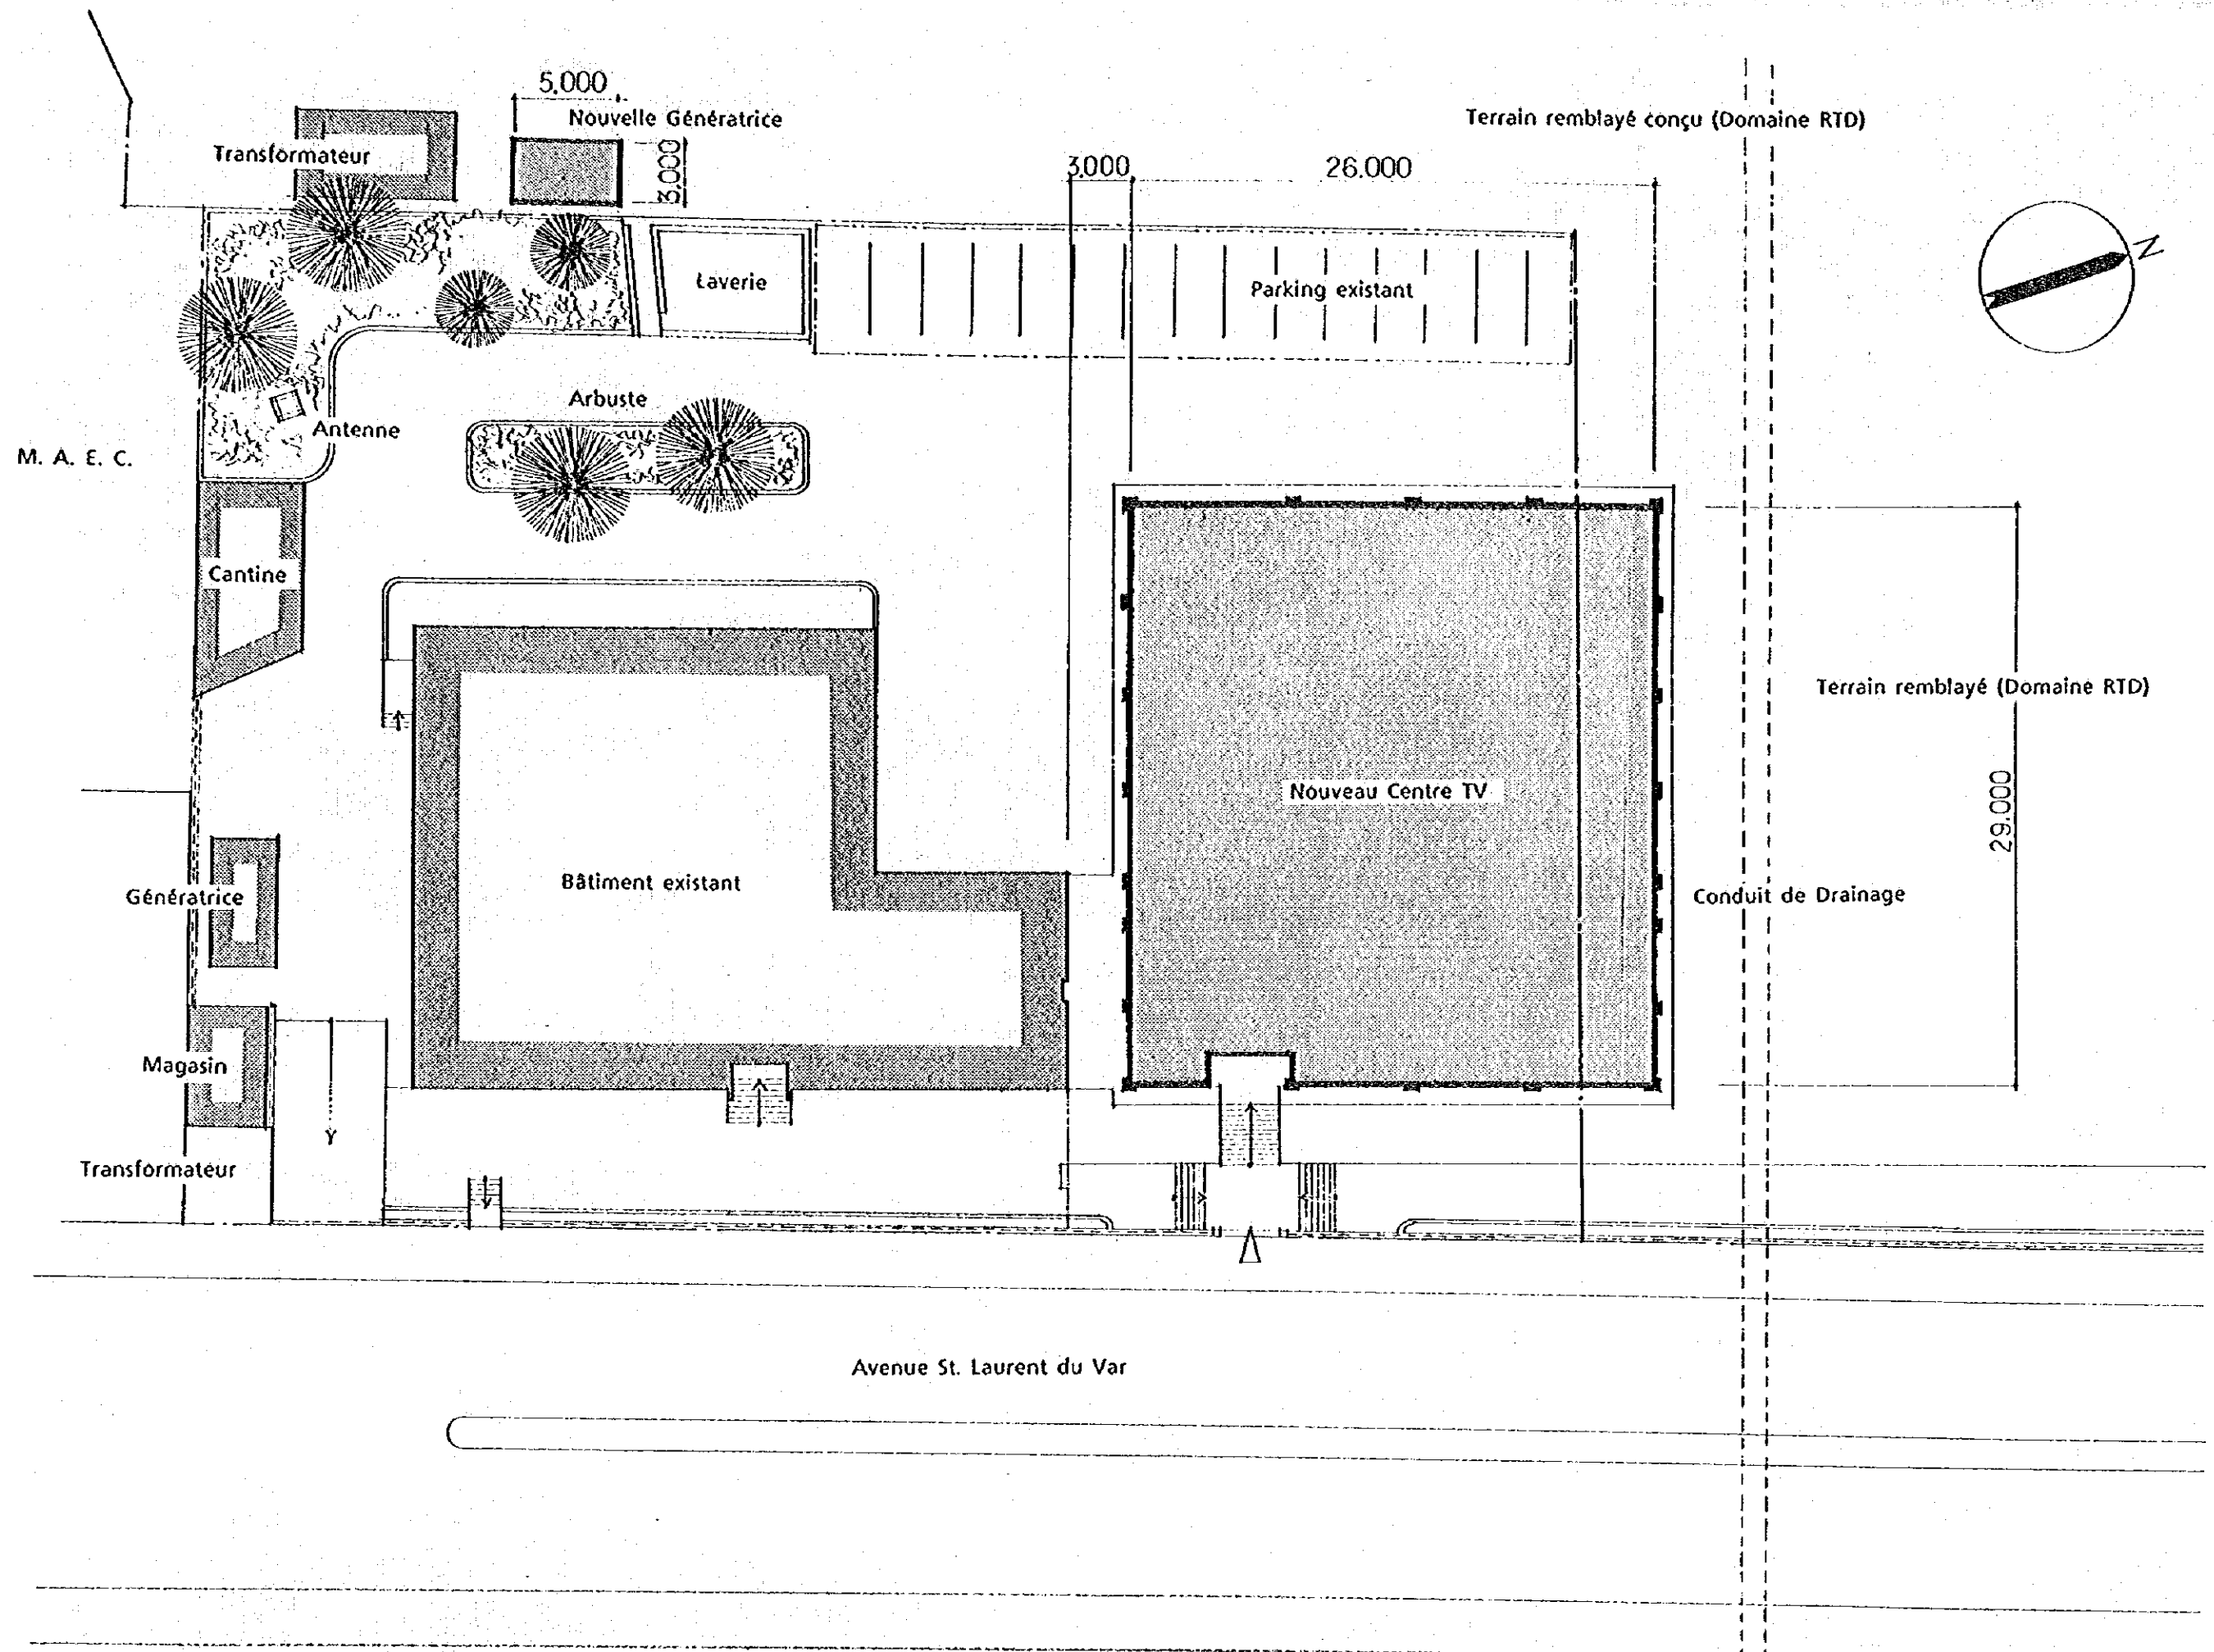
PLAN DU CENTRE DE LA TELEVISION (DISPOSITION DU BATIMENT)
